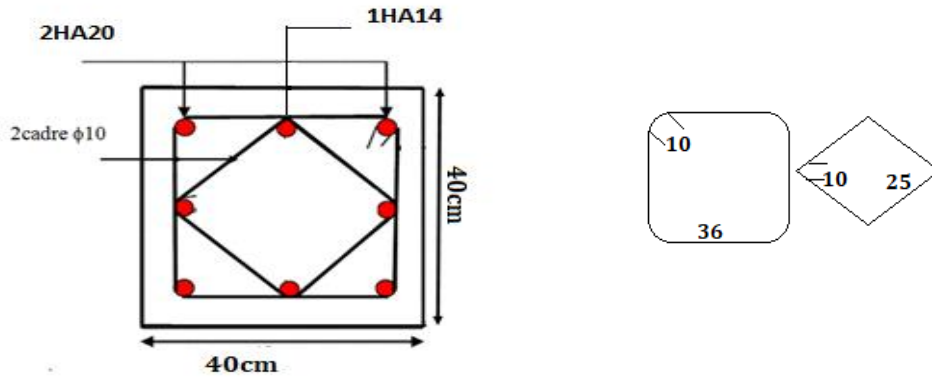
Schéma de ferrailage de poteau 3<sup>eme</sup> et 4<sup>eme</sup> étages.
